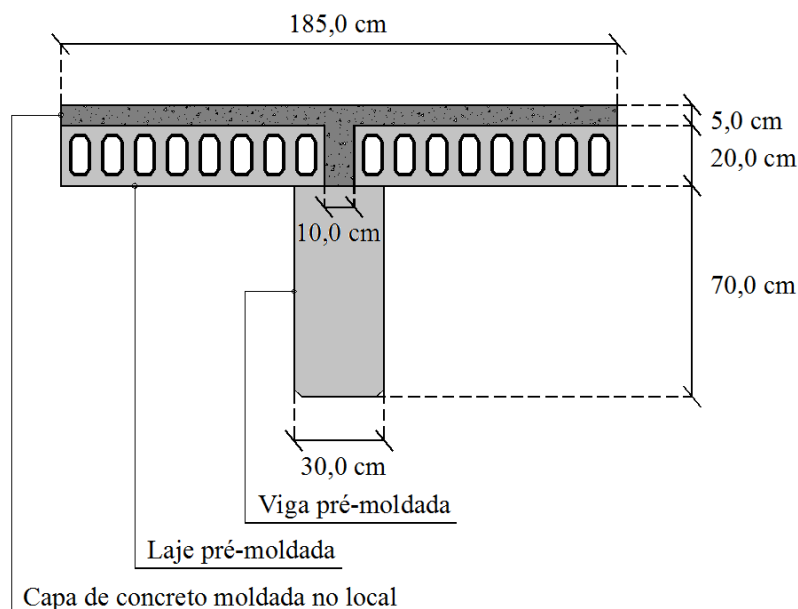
Geometria das vigas da estrutura nos eixos X e Y.
